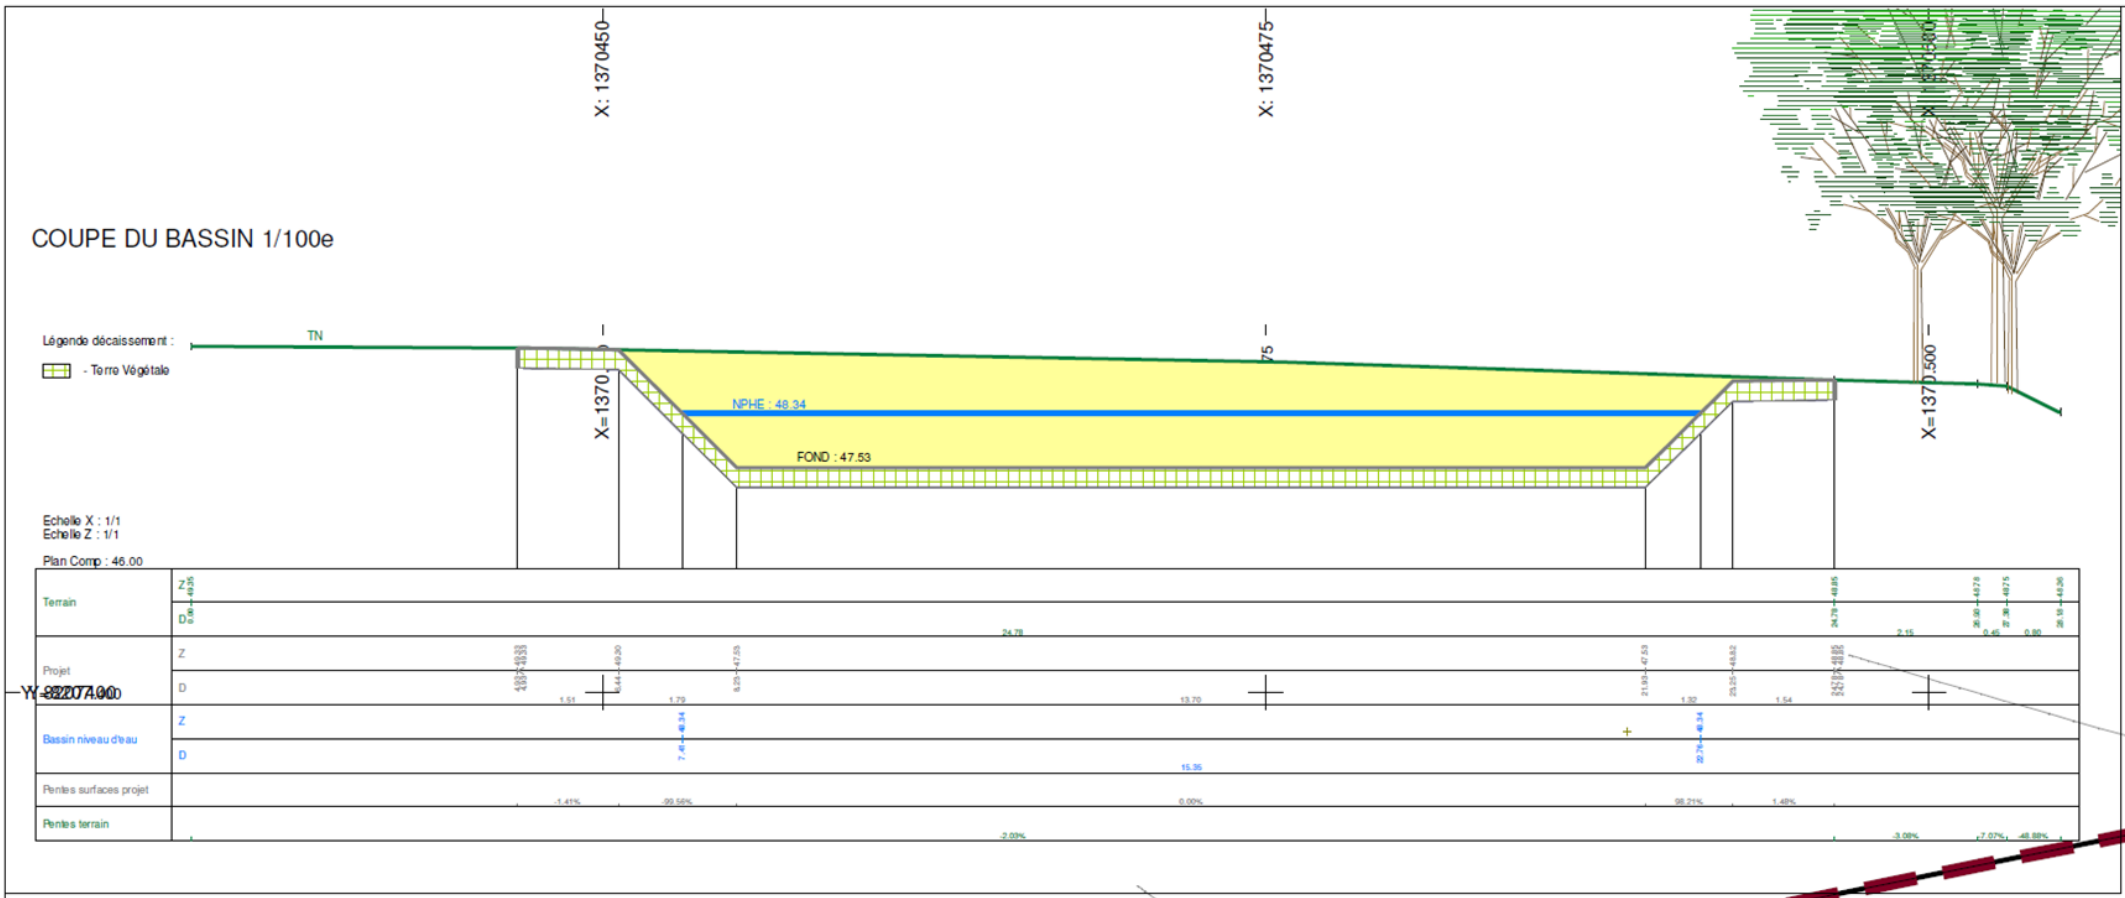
Coupe du bassin d'infiltration (Source : TECAM)
